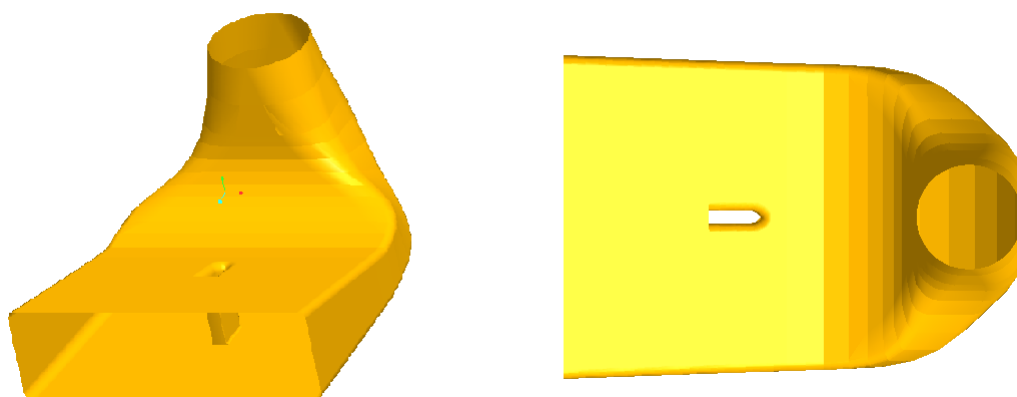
Saugrohr mit Stützmauer (links), Draufsicht des Saugrohres (rechts).
